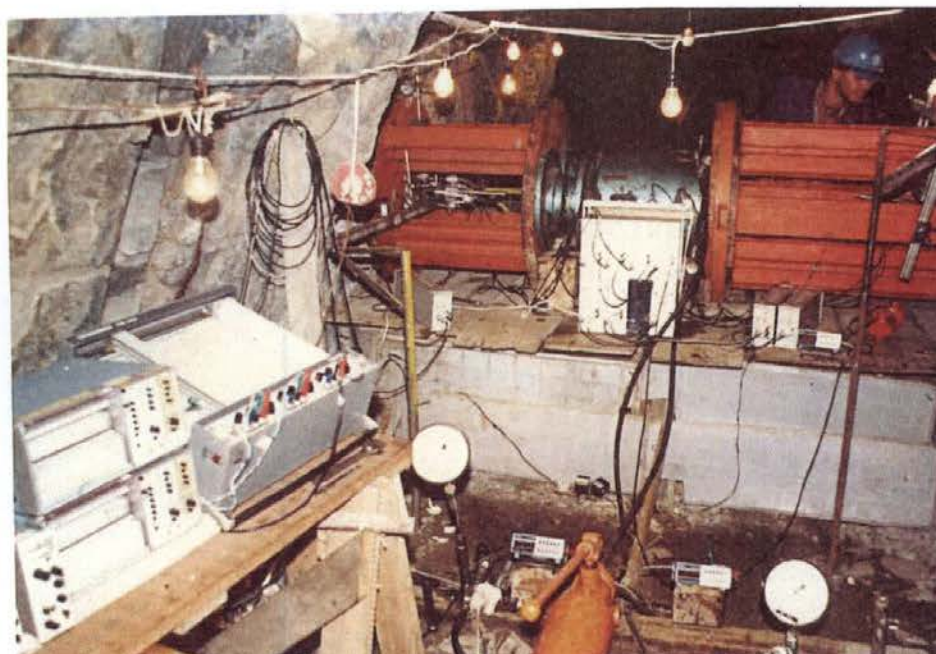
Ensaio de deformabilidade *in situ* em galeria na fundação da barragem
